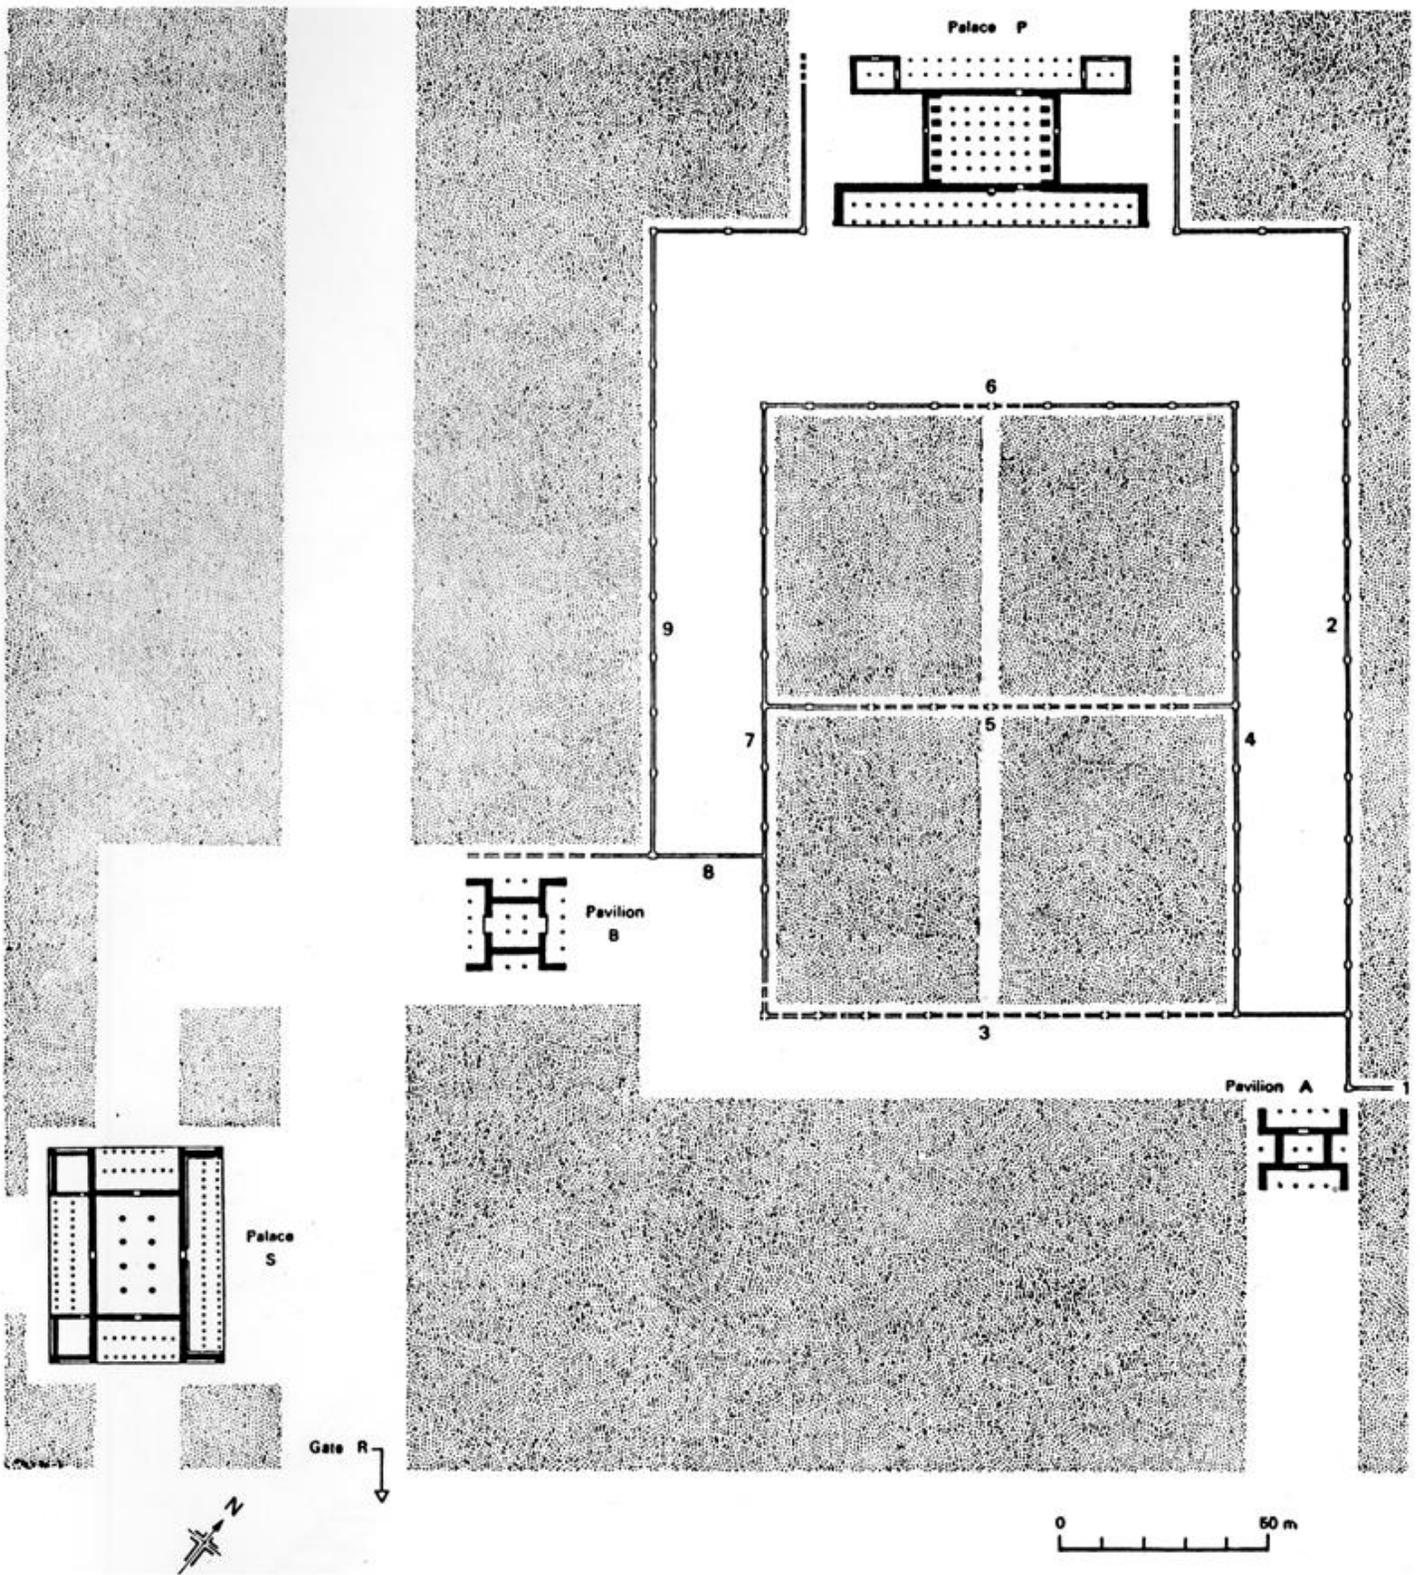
Planta do Pavilhão B. Fonte: STRONACH, 1978.
